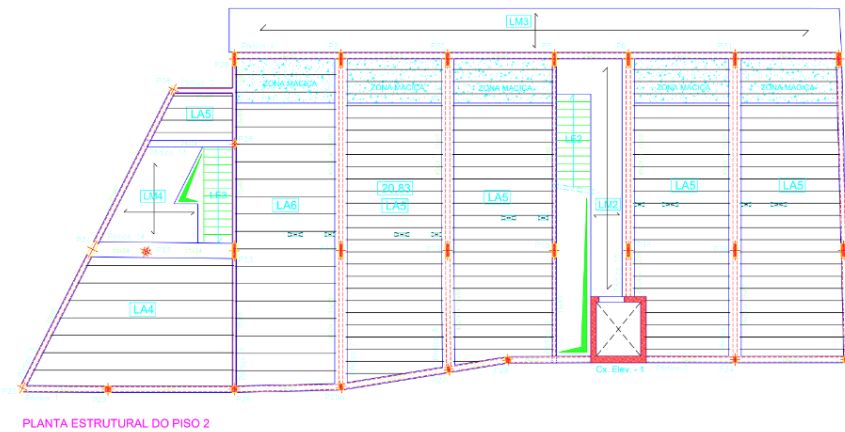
Planta estrutural piso 2 edifício novo.
